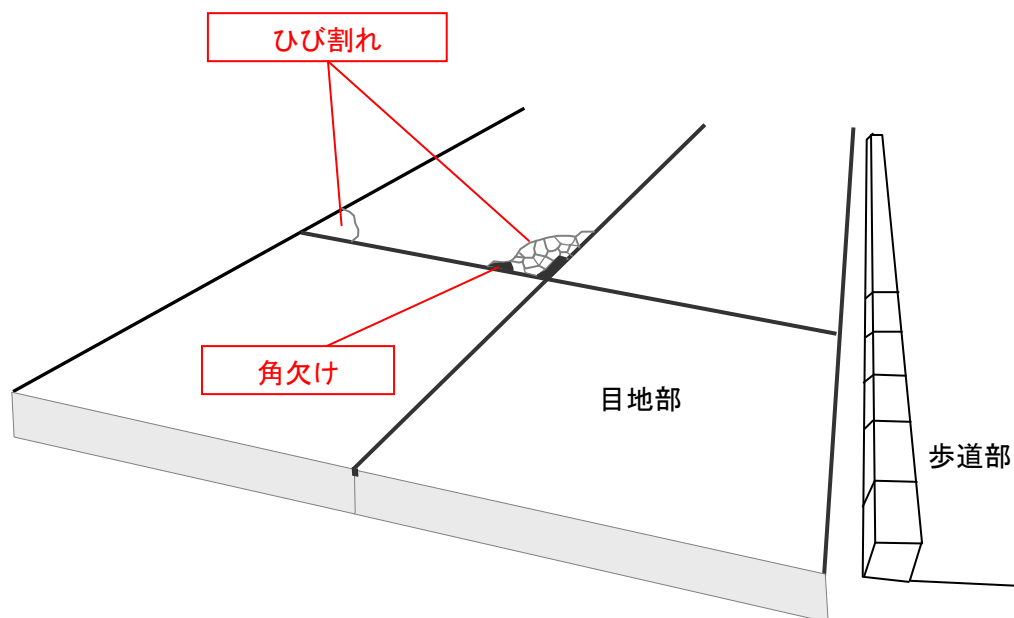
隅角部のひび割れ・角欠けのイメージ
